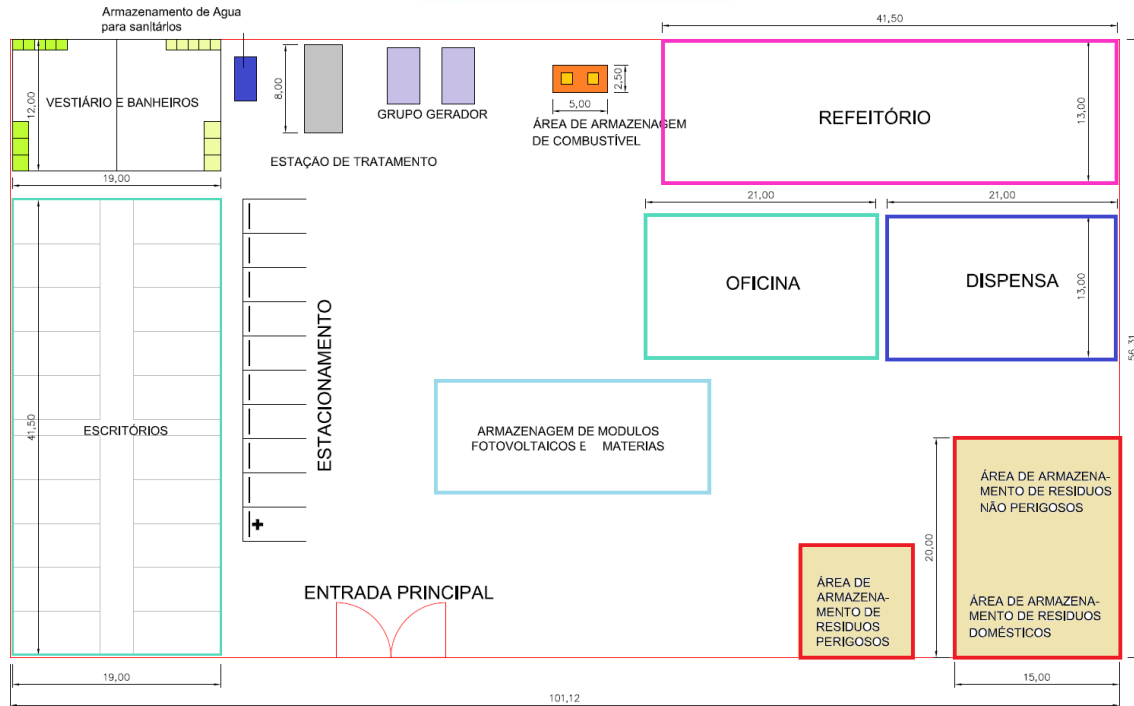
Layout das instalações da área comum utilizadas durante a obra.
